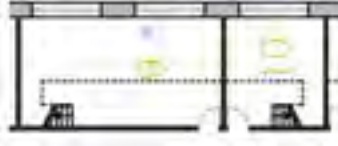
Pianta ufficio 9 – Piano terra. Il posizionamento dei tinytag è indicato dalla stellina celeste.
